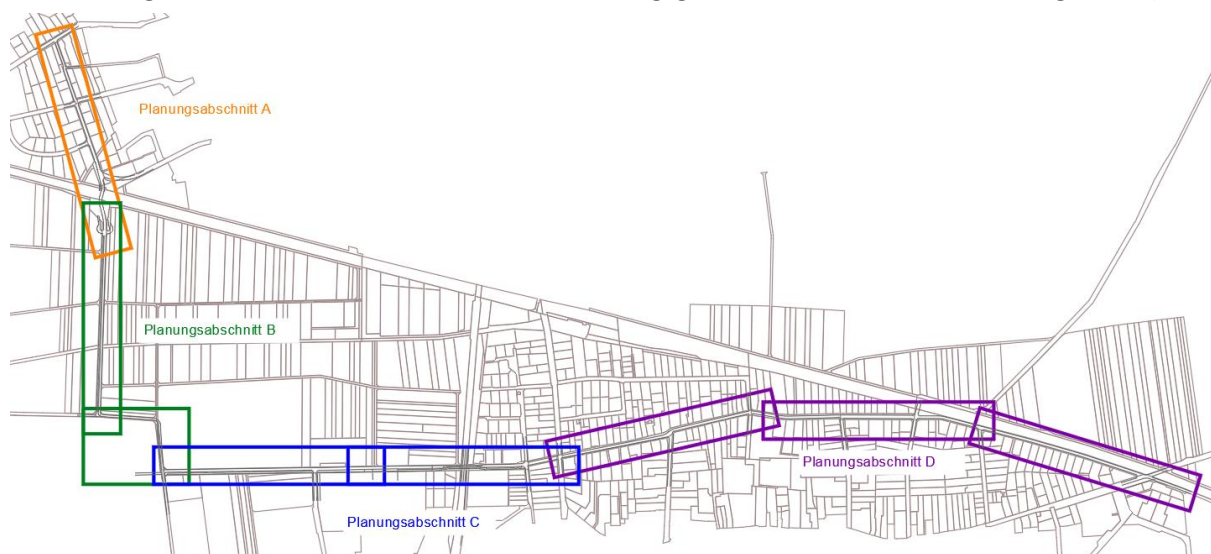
Zur besseren Betrachtung zeigt Anlagen 1 eine Übersichtskarte der Planungssache
